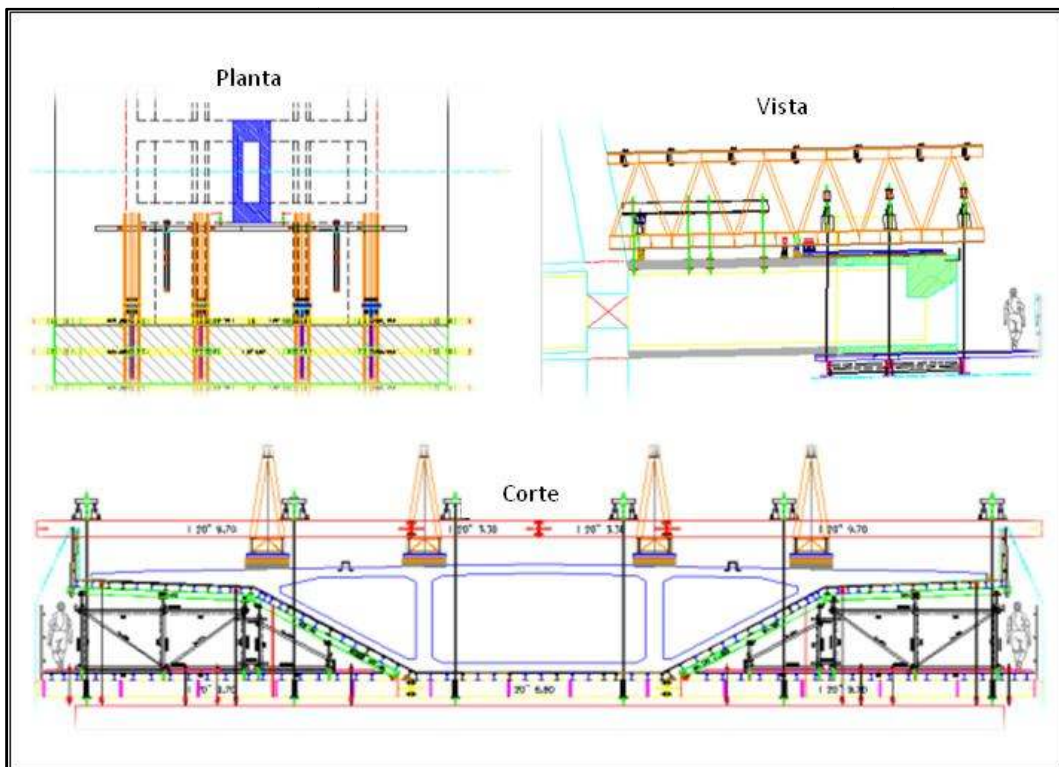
Esquema de planta, vista e corte referente ao Balanço Sucessivo com treliça lançadeira e aduelas moldadas no local da obra do Rodoanel – OAE 402 (M-150) – Ilha Do Guararé/SP – Camargo Correia
